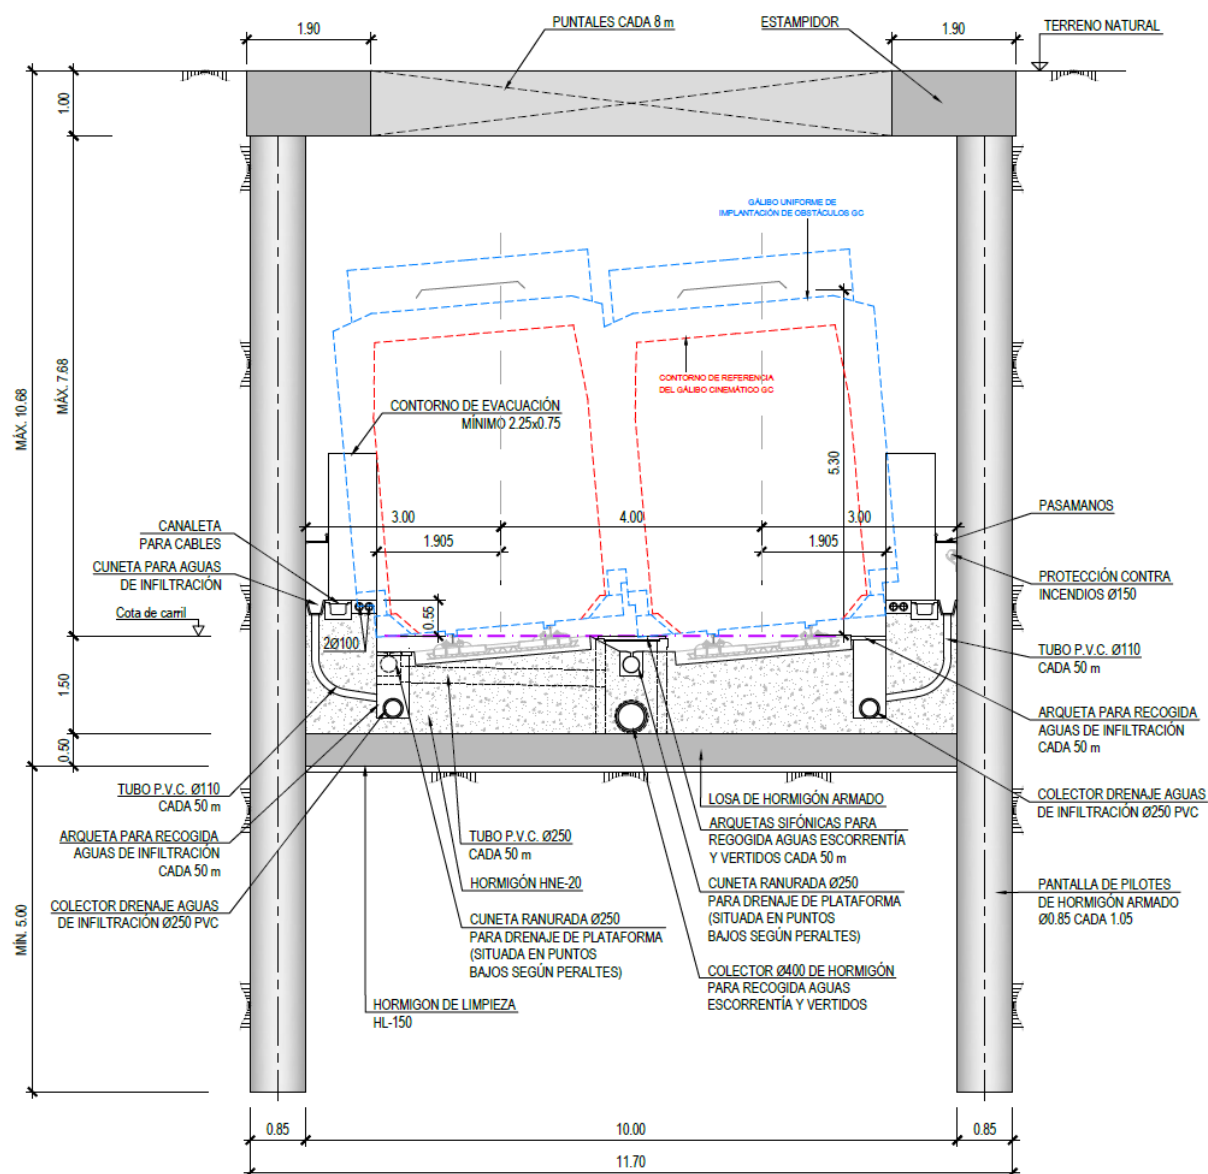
c.- Sección tipo 3 en rampas (ST-R3).
